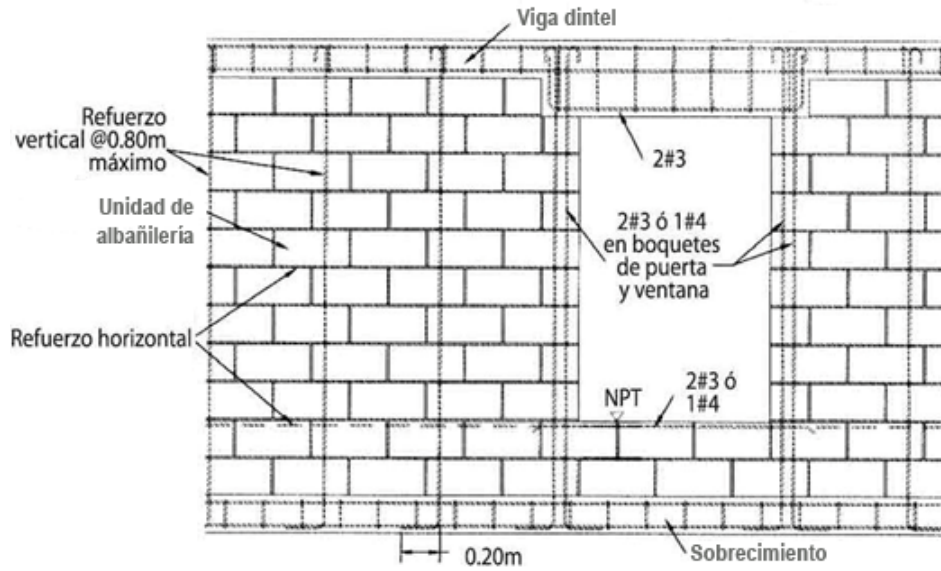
Detalle las barras verticales de refuerzo (Bravo, 2007)
